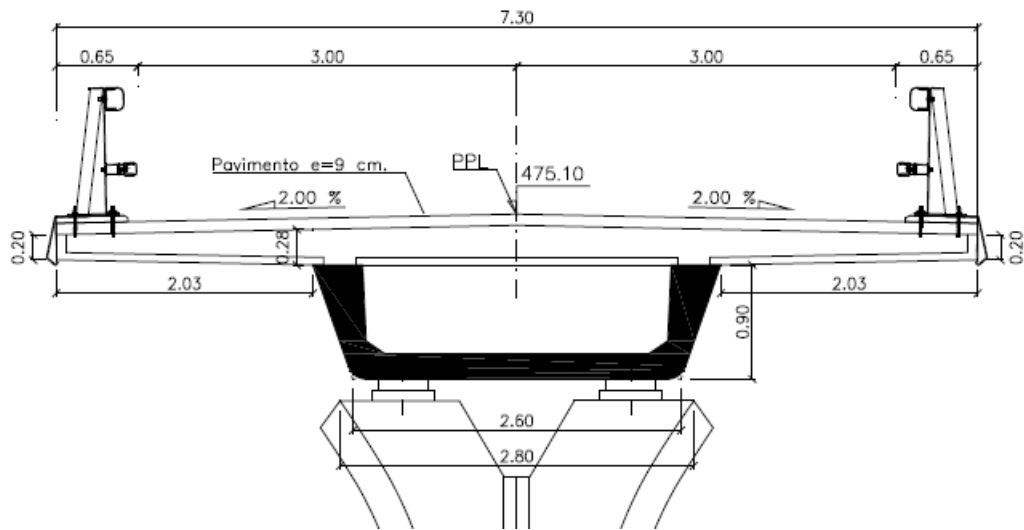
Detalle Estructura 4 y 5 Alternativa 1
